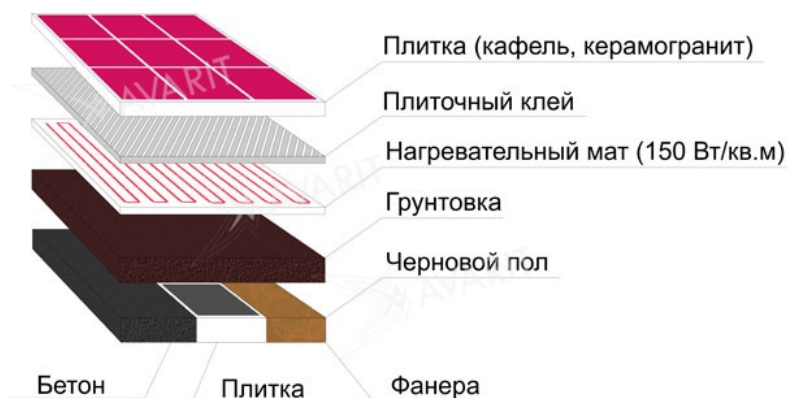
Установка нагревательного мата под плитку (комфортный обогрев)
